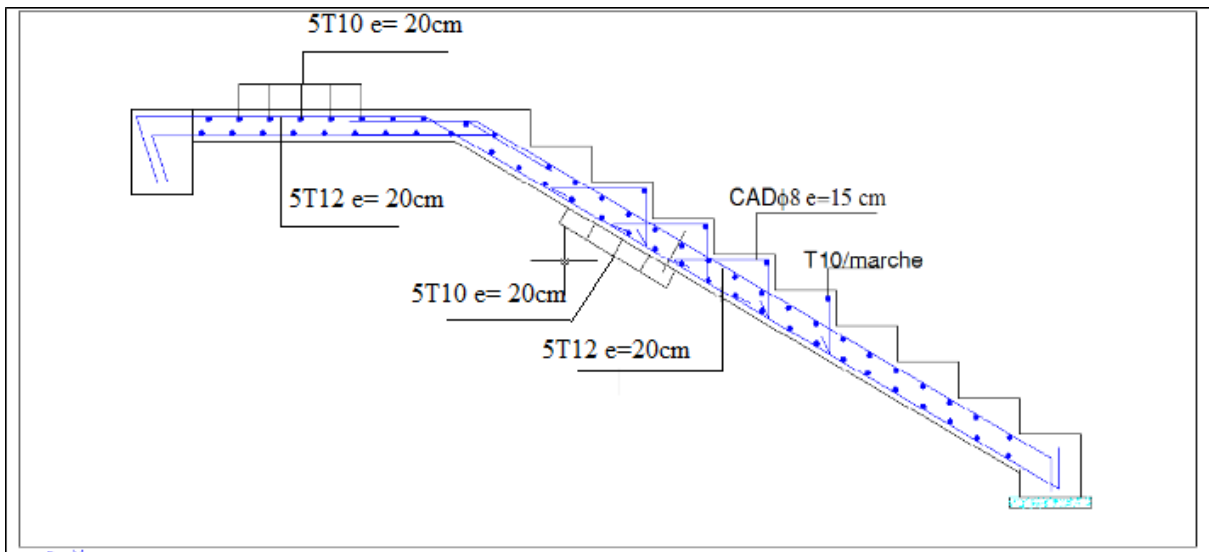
Schéma de ferrailage des escaliers S-Sol.
